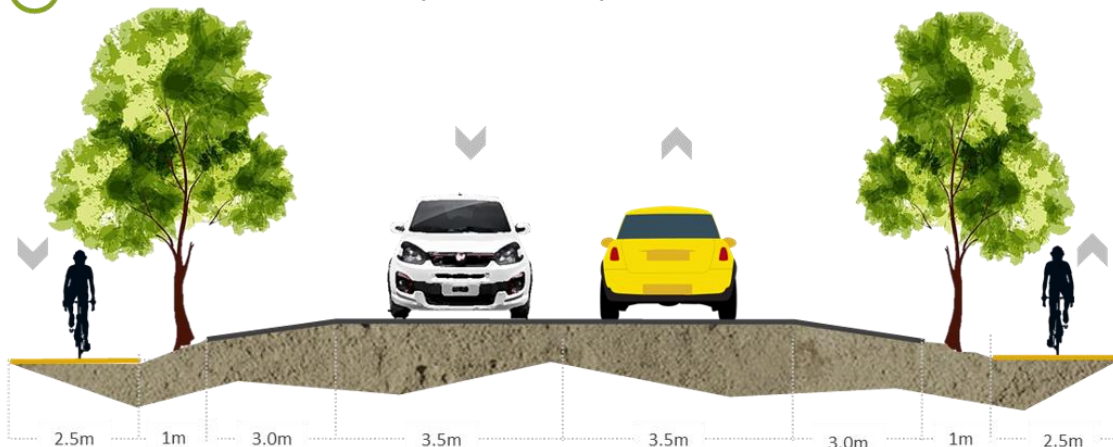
PROPUESTA DE SECCIÓN VIAL CAMINOS RURALES DE SAN LUIS RÍO COLORADO
